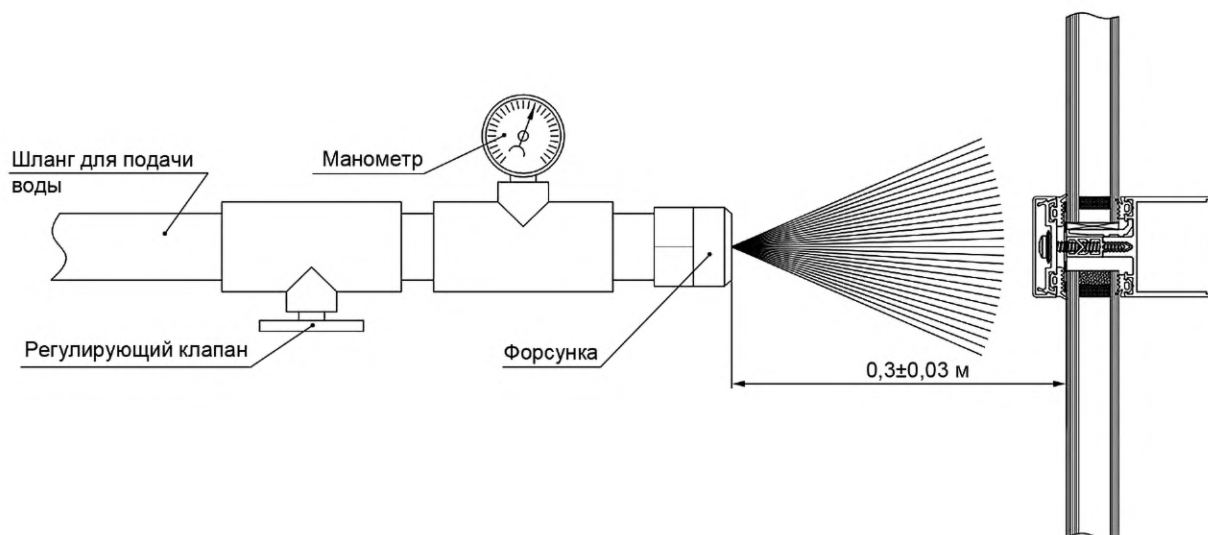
Рекомендуемая схема пролива воды при испытании фасадной светопрозрачной конструкции
